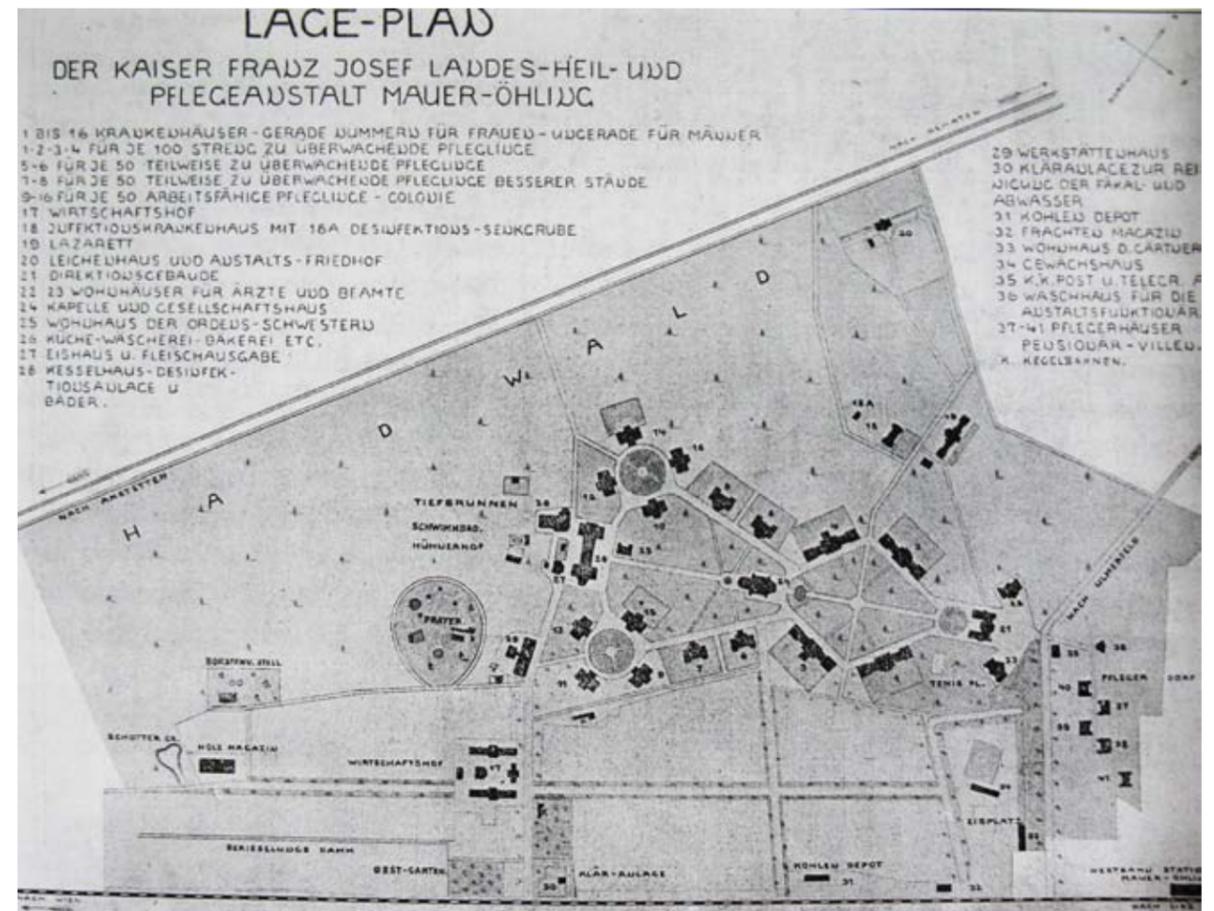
Lageplan „Irrenanstalt“ Mauer Ohling
